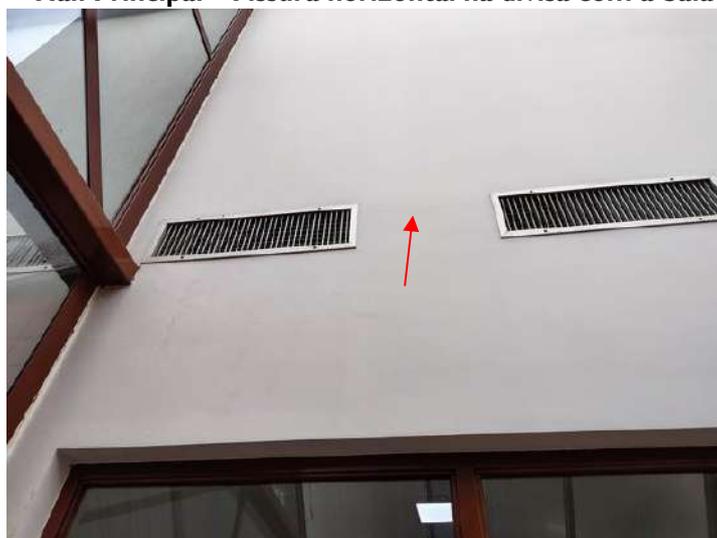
Hall Principal – Fissura e deterioração da pintura acima da porta da recepção
